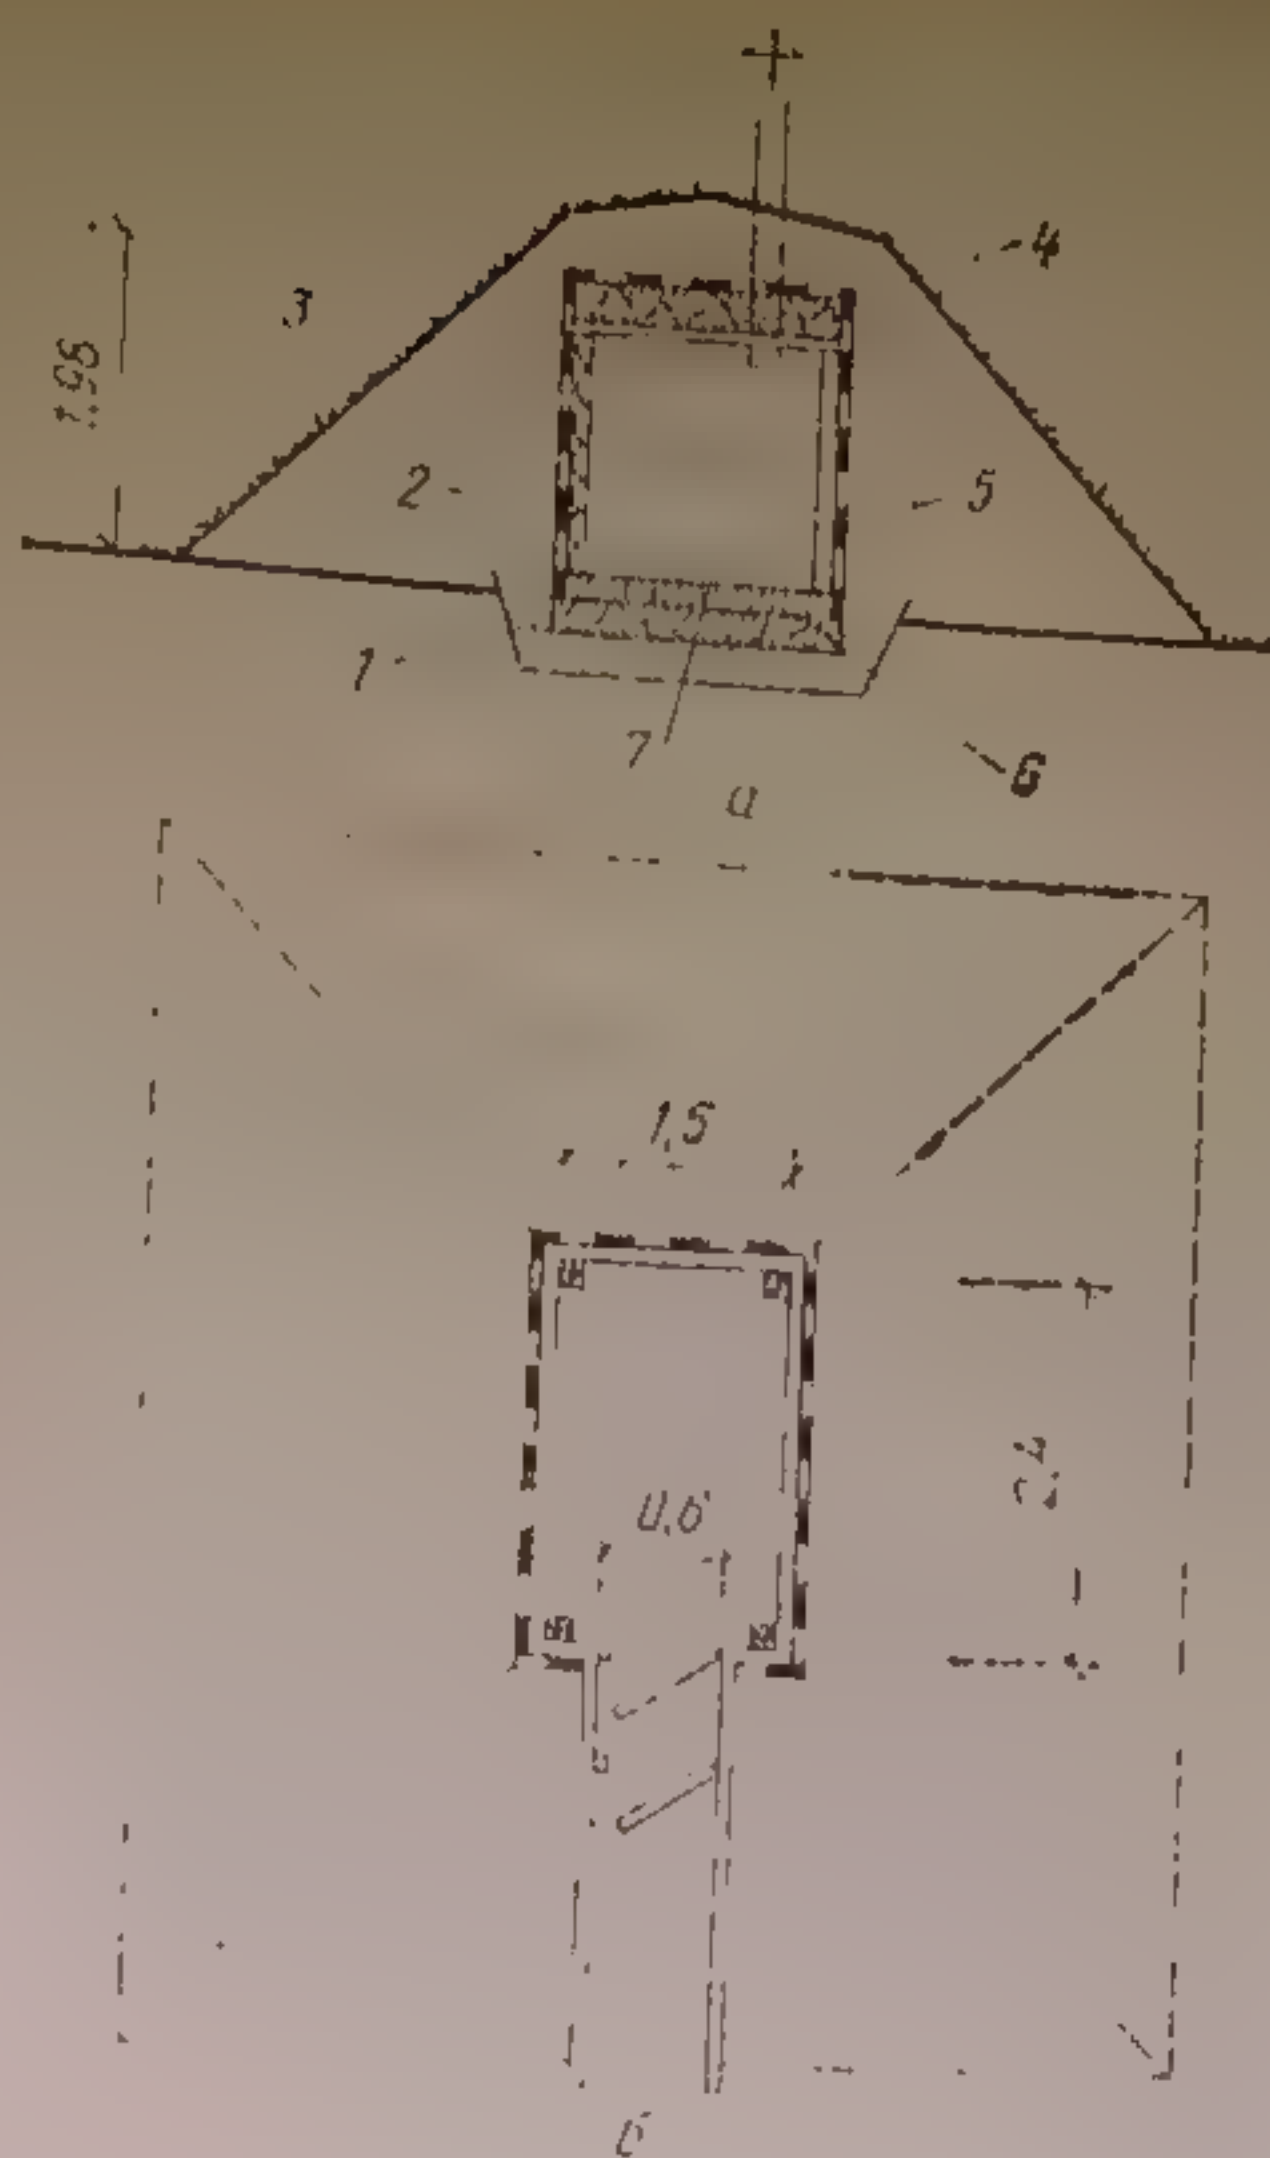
Наземный погреб с обваловкой: а — разрез; б — план; 1 — песчано-щебеночная подготовка; 2 — стены из горбыля; 3 — обваловка; 4 — глиносолома; 5 — гидроизоляция (пергамин); 6 — глиняный замок; 7 — пол [кирпич на «ребро»]
